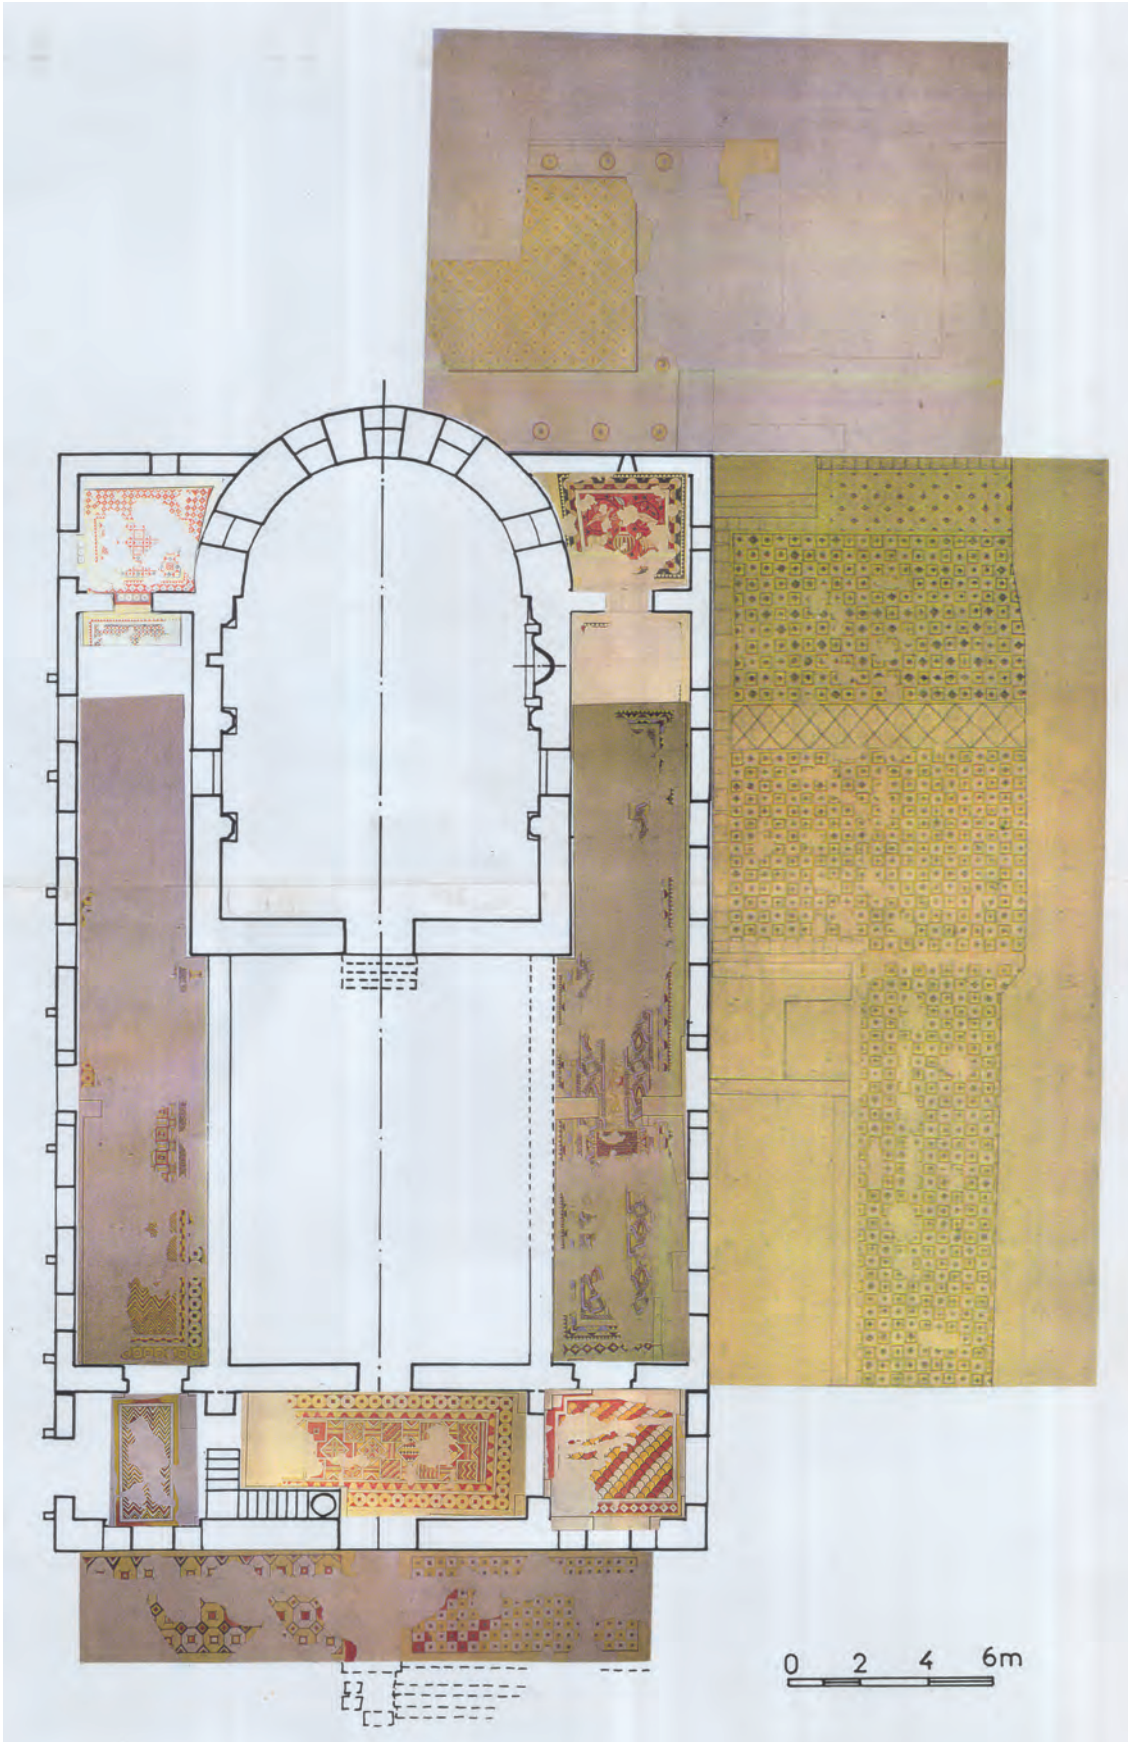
Ala Çami, Grundriss, ergänzt mit freigelegten Mosaiken.
